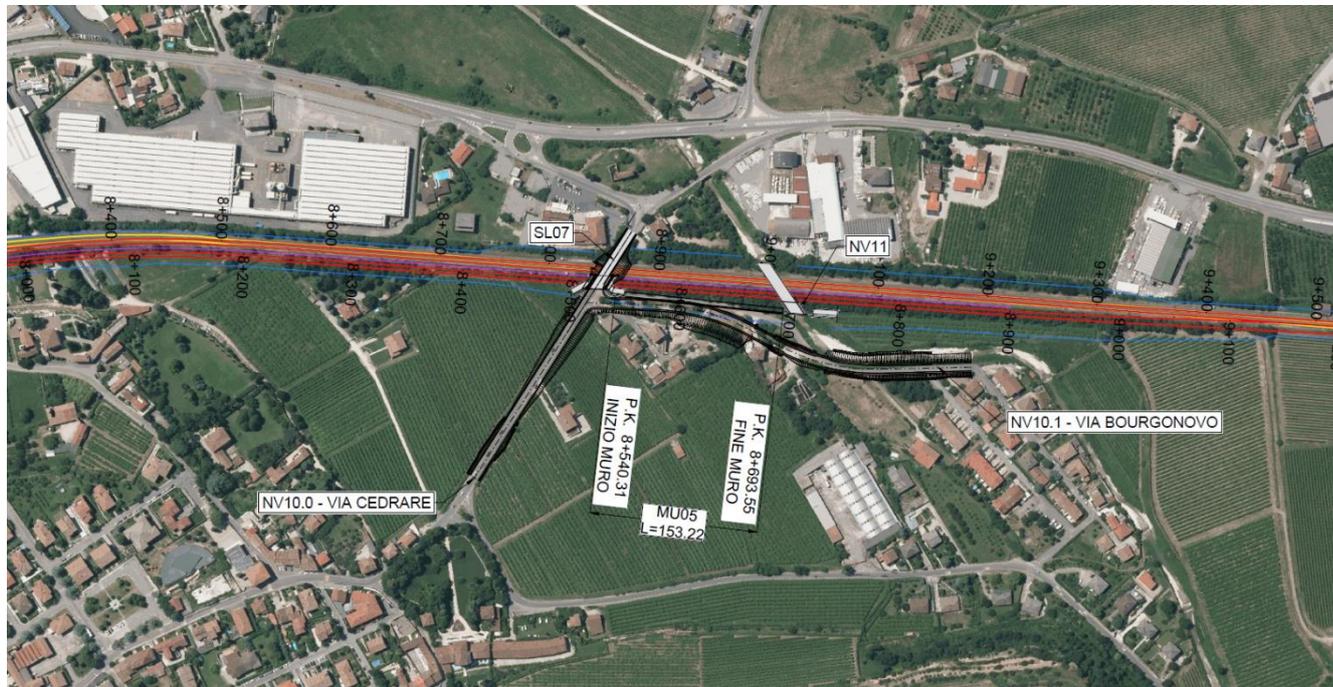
NV10 – Stralcio planimetrico su ortofoto di Via Cedrare e Via Borgonuovo
